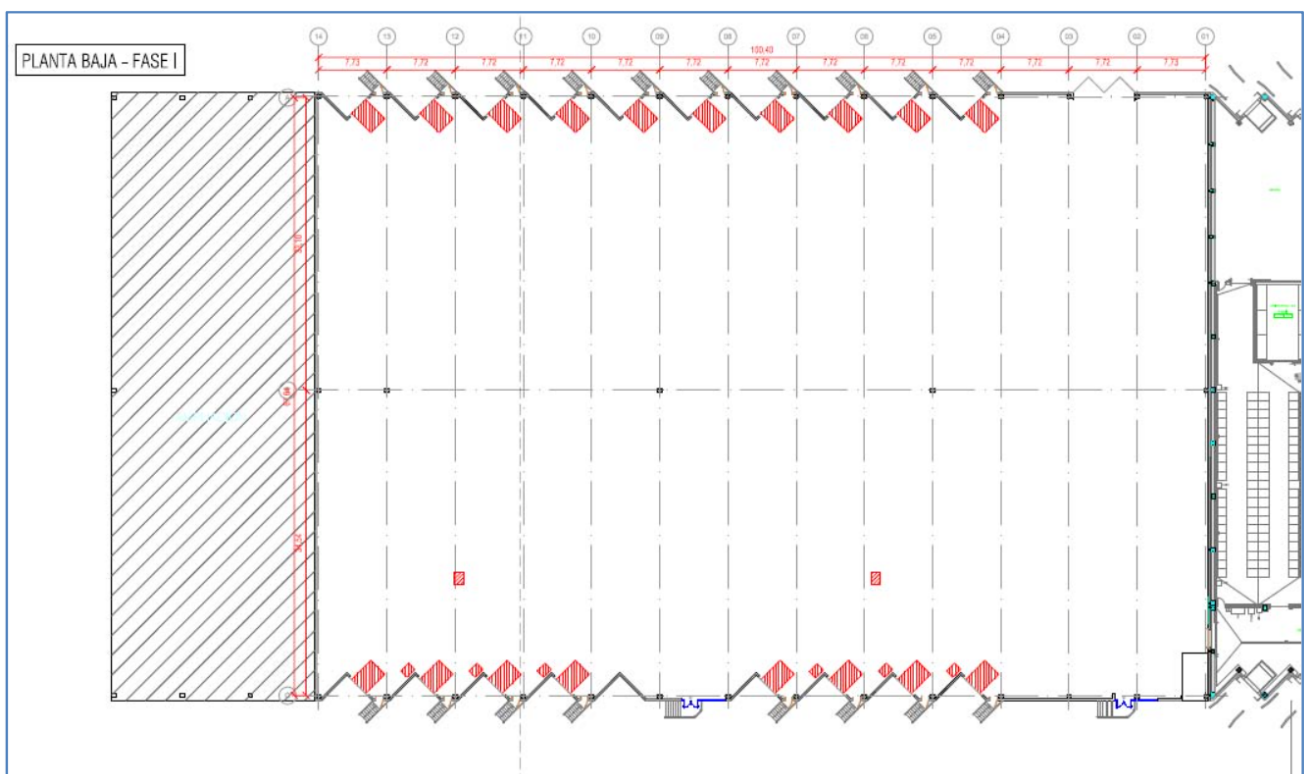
Plano estructura planta baja escenario convencional Fuente Elaboración propia
